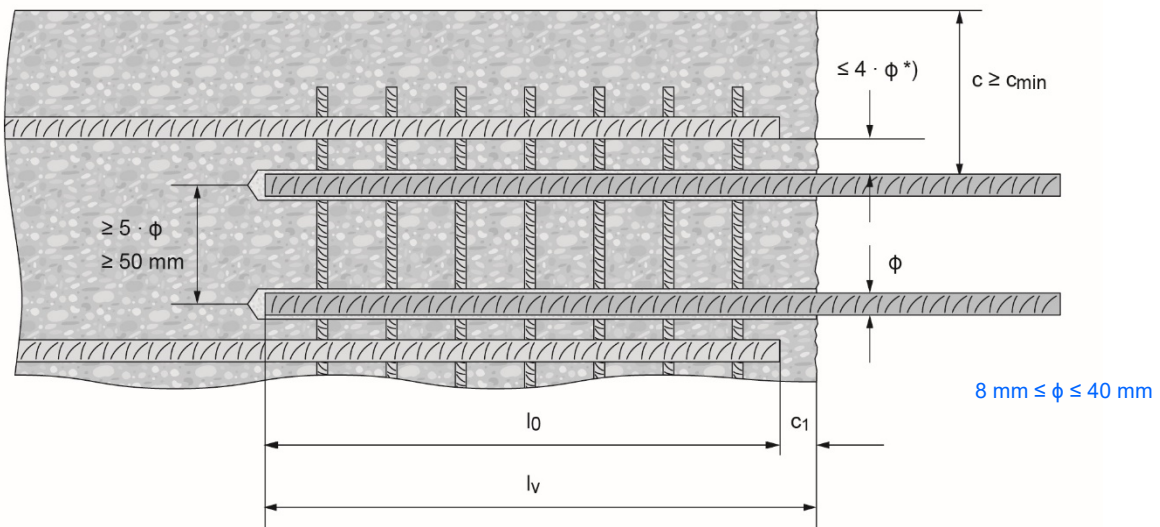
Abstände zwischen existierenden und nachträglich zu installierenden Bewehrungsstäben und Abstand zum (parallelen) Rand.
